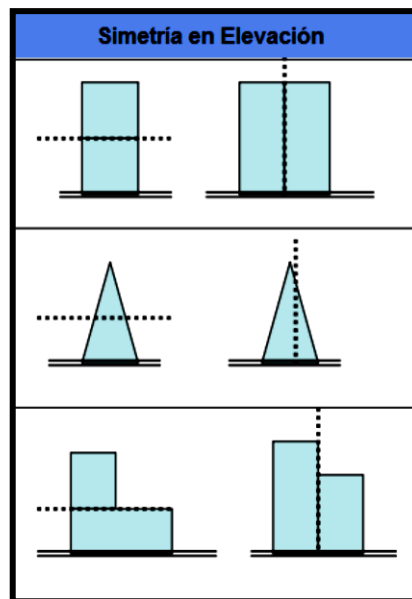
10. Simetría en Elevación. Fuente: Propia.
